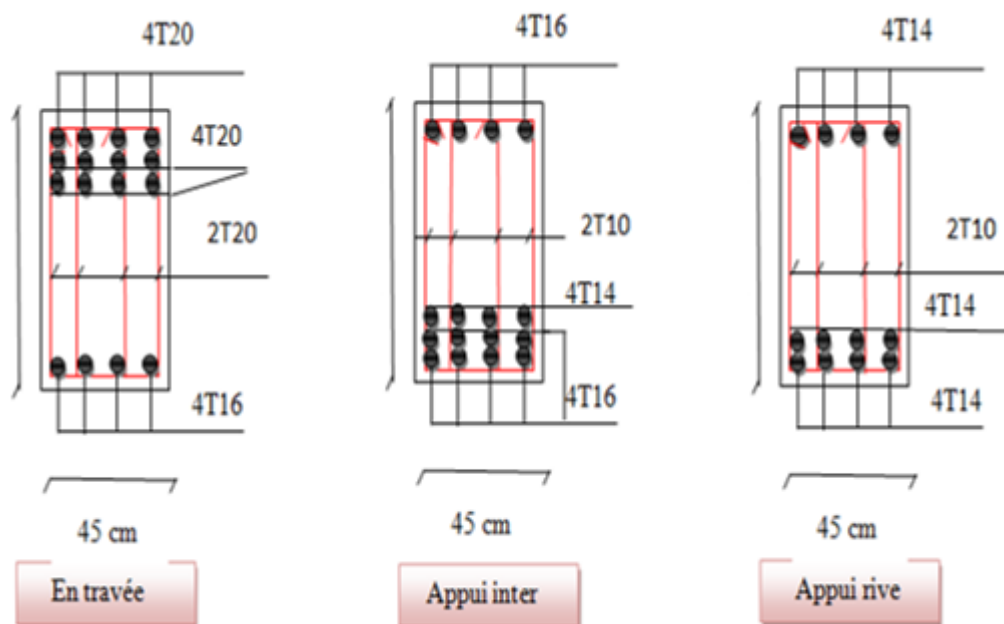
Ferrailage de la poutre de libage suivant le sens longitudinale.
